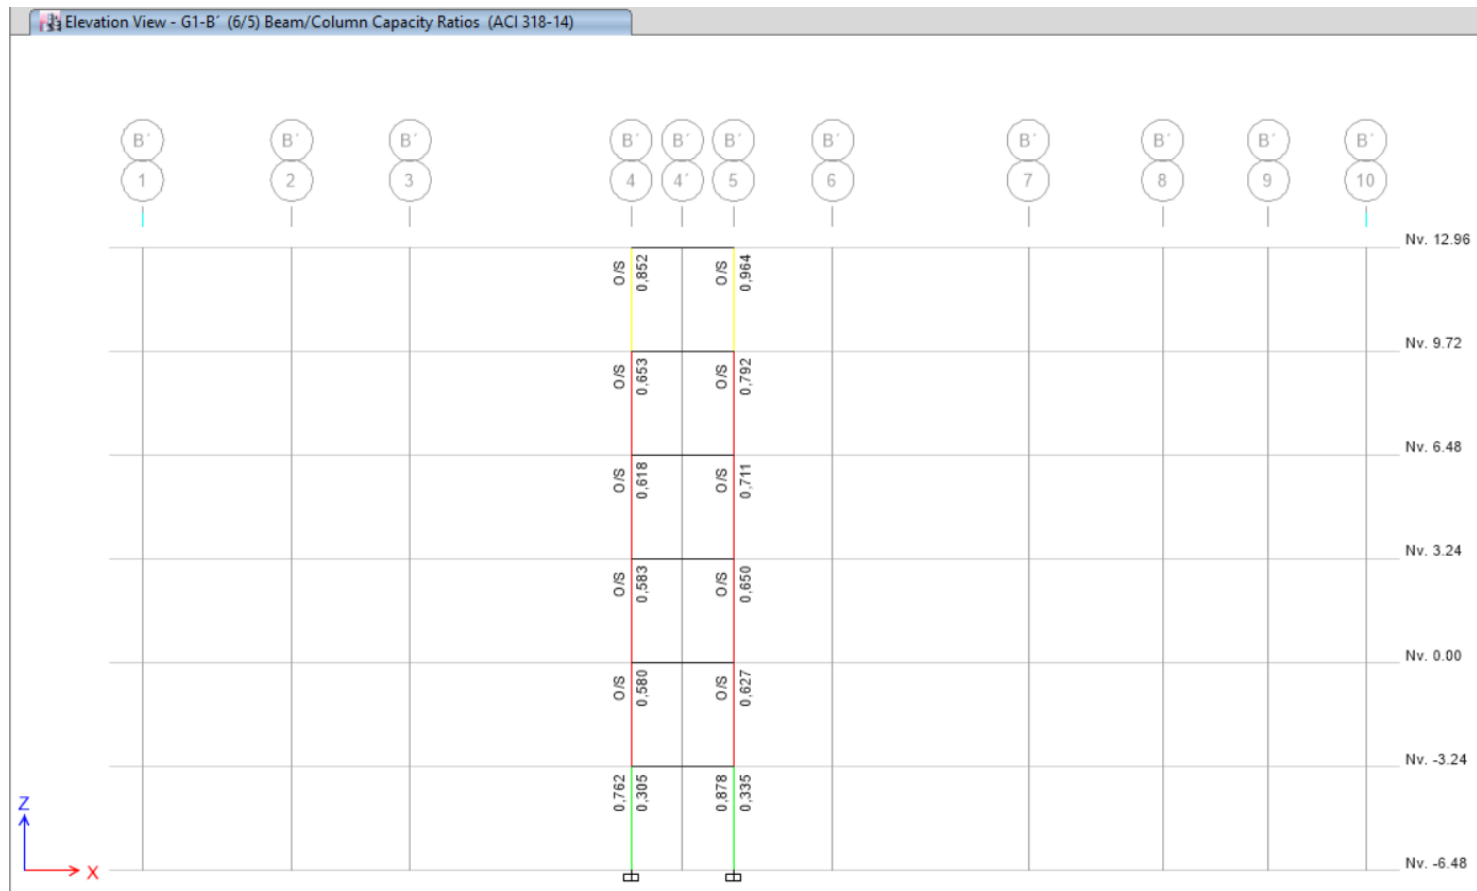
Vista en elevación de factor de capacidad unión viga-columnas, pórtico eje B.
